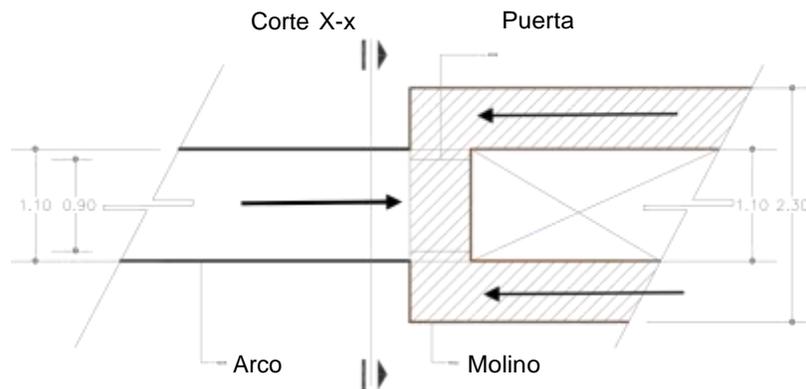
Y-Y'. Conexión de arco con muro de molino visto en planta. Elaboración propia AutoCAD 2017.
